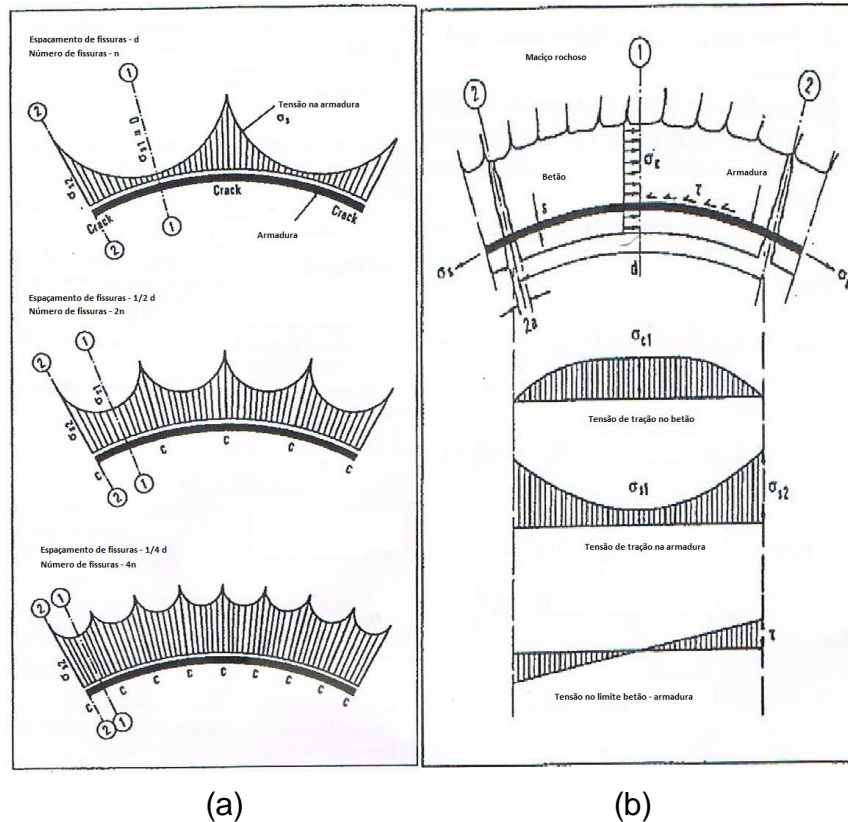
Revestimento fissurado: a) desenvolvimento das fissuras e distribuição de tensões na armadura; b) tensões na armadura, no betão e no limite entre a armadura e o betão [7].
